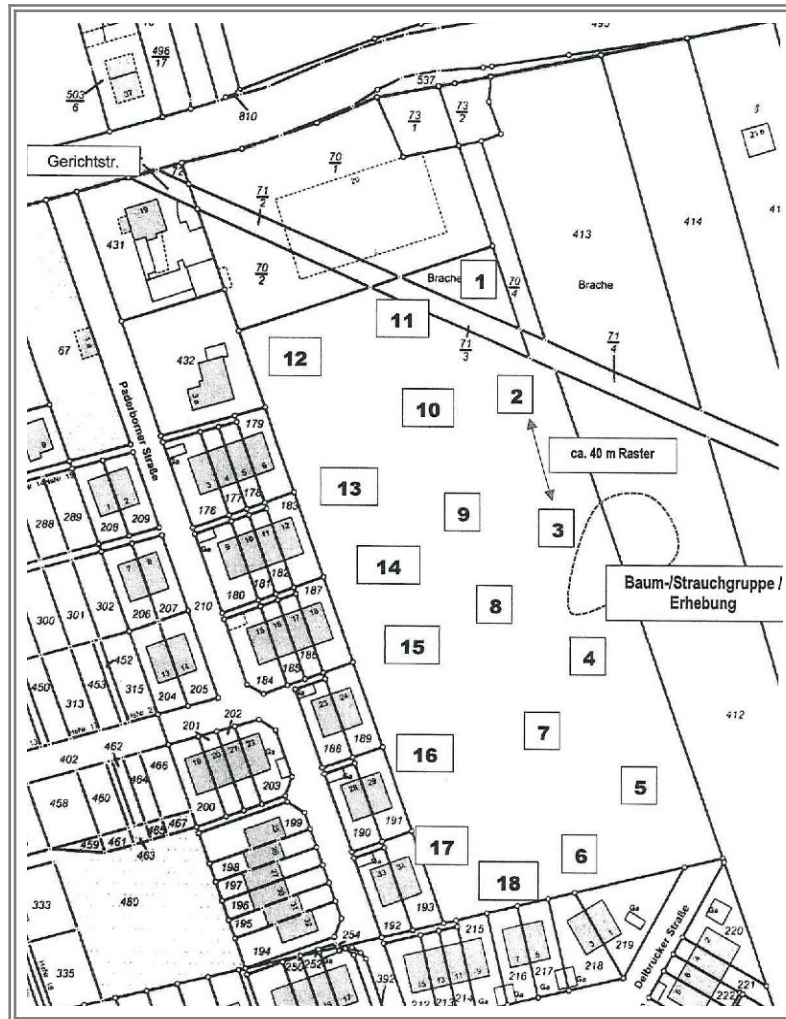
Lage der Kernbohrungen / Rammsondierungen der Baugrunduntersuchung
